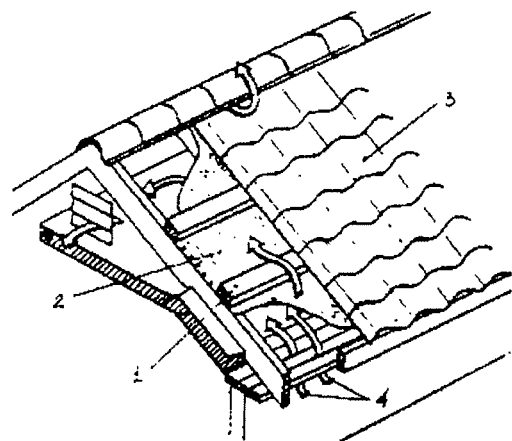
Конструкция крыши с кровлей из металлочерепицы:
